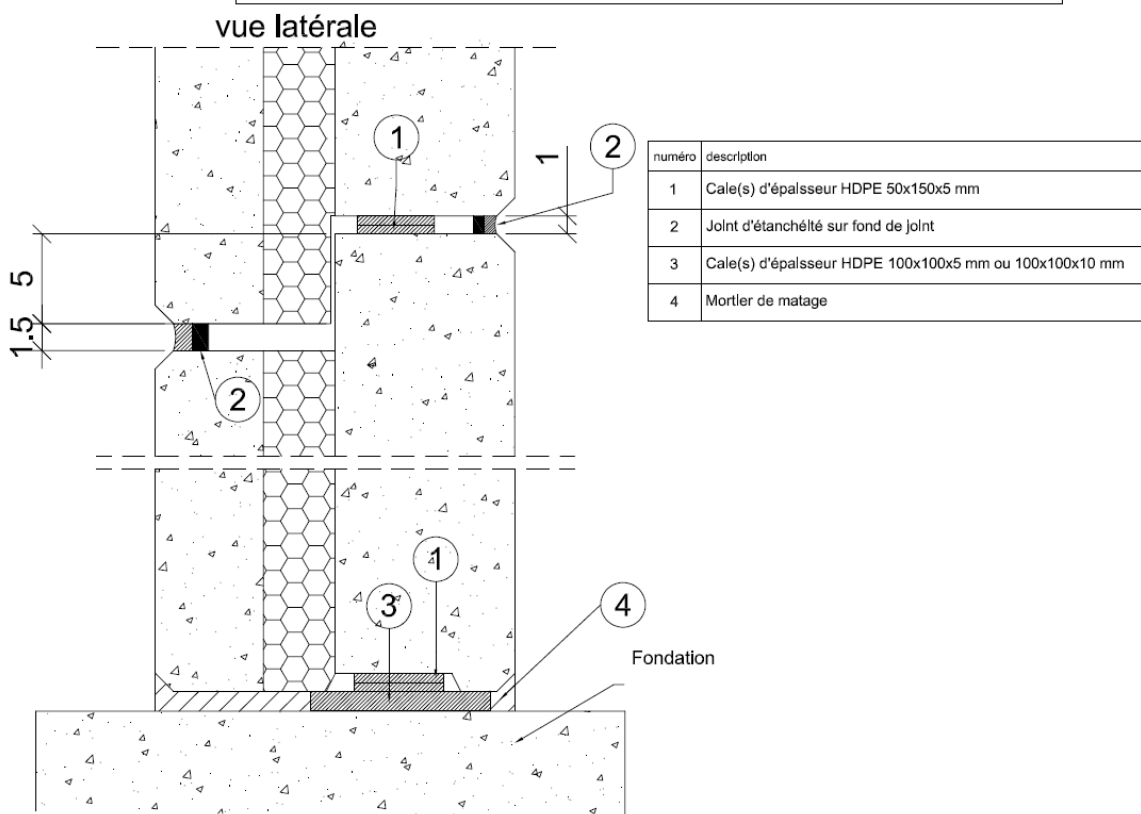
Pose des panneaux dans le cas d'une façade d'un bâtiment de logement (exemple)
